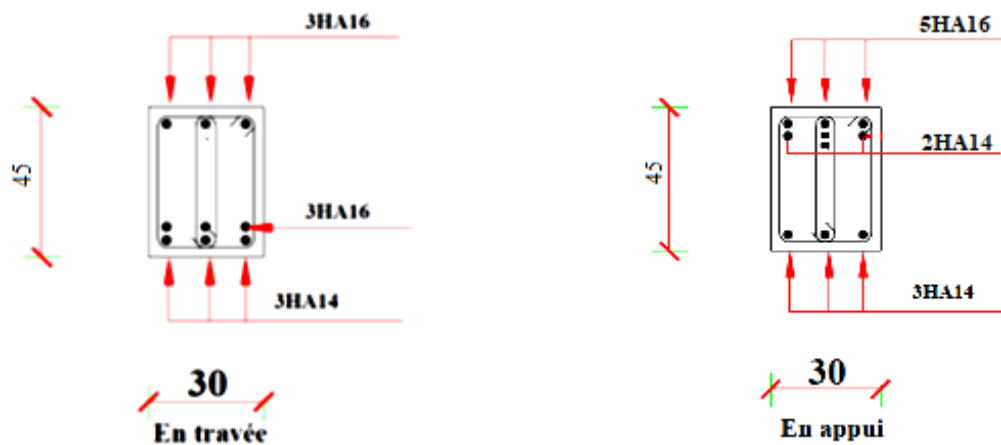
Croquis de ferrailage de la poutre principale 1
